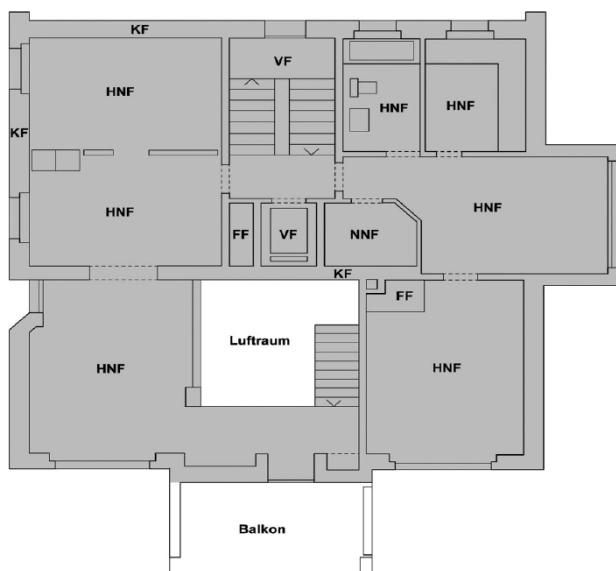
Geschossflächen, illustriert anhand des zweiten Vollgeschosses
